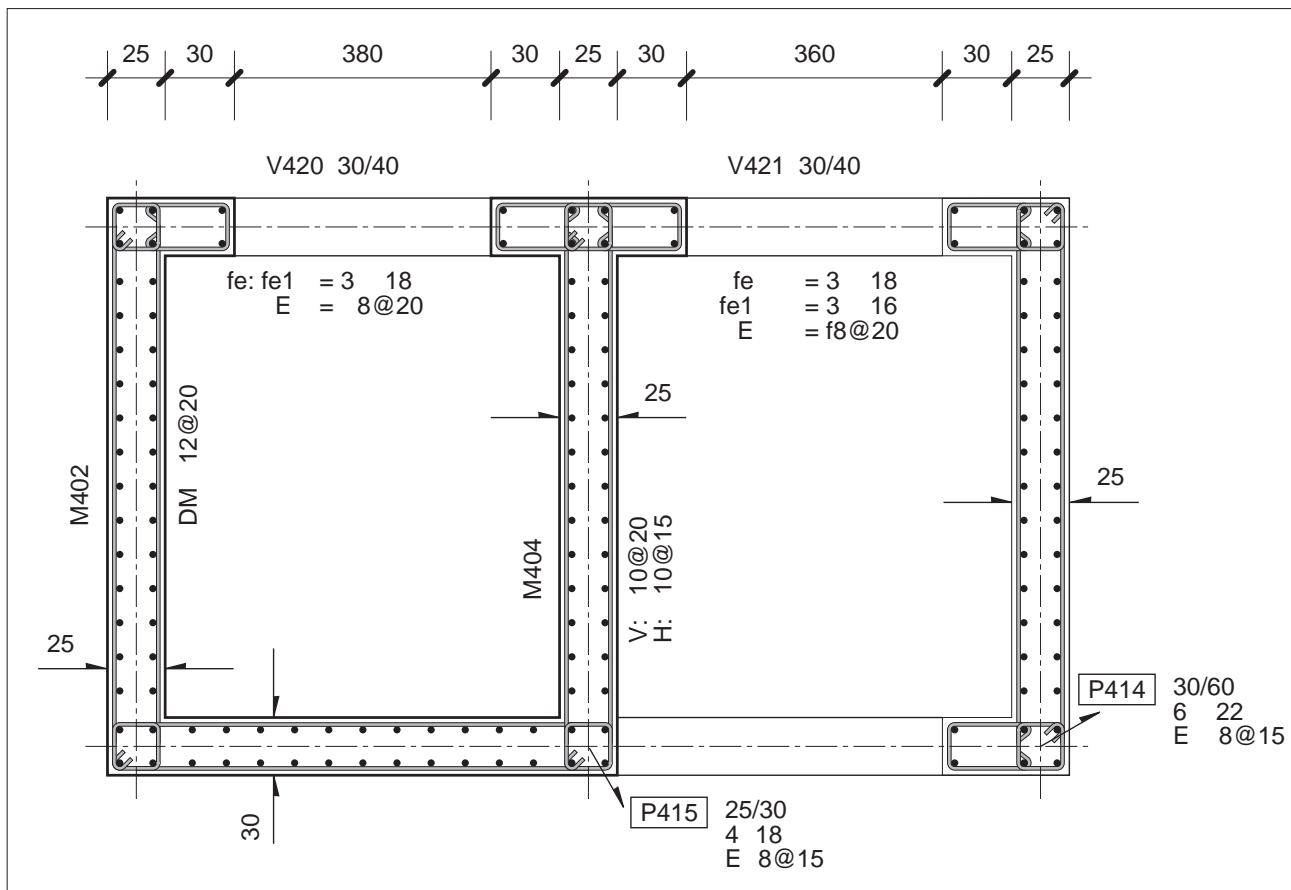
Plano de Conjunto Vigas, Columnas y Muros (fuera de escala).
